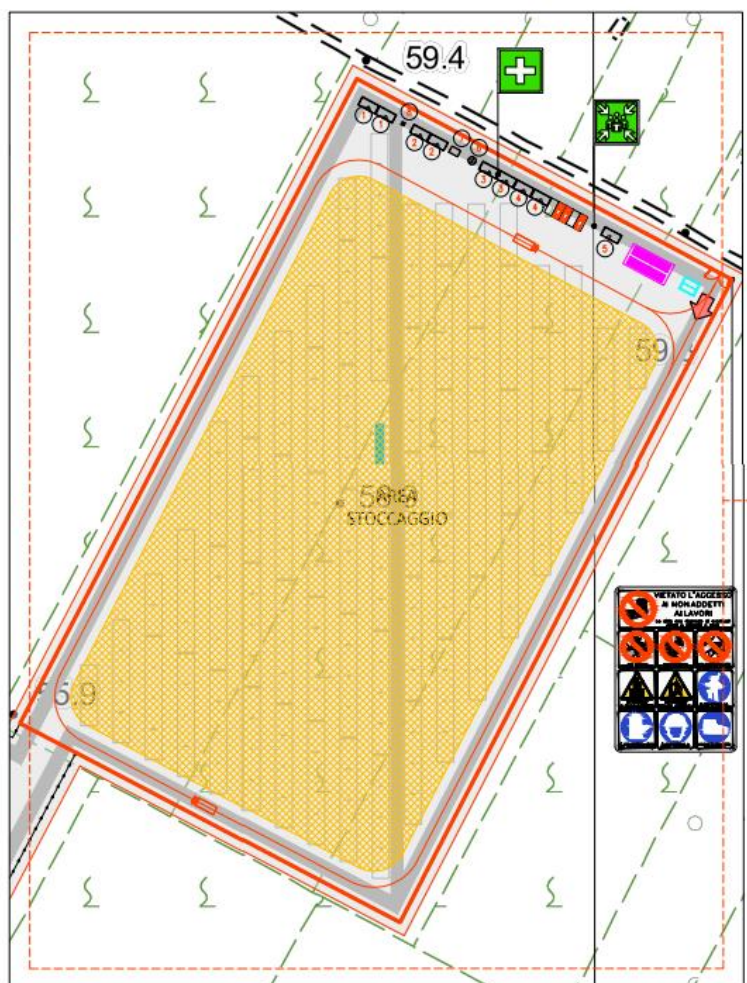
Stralcio dell'area stoccaggio di cantiere
